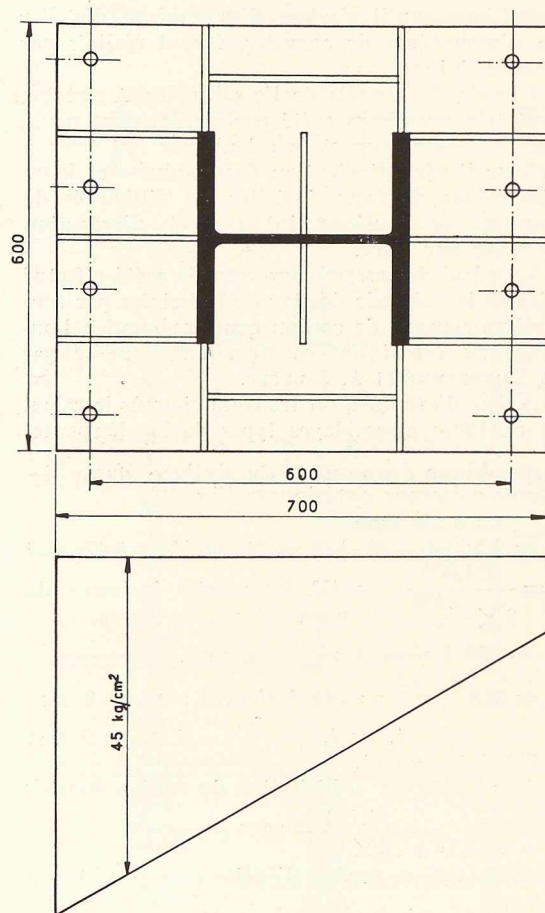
Vue en plan d'un pied de colonne d'un portique courant du bâtiment Moulin.
